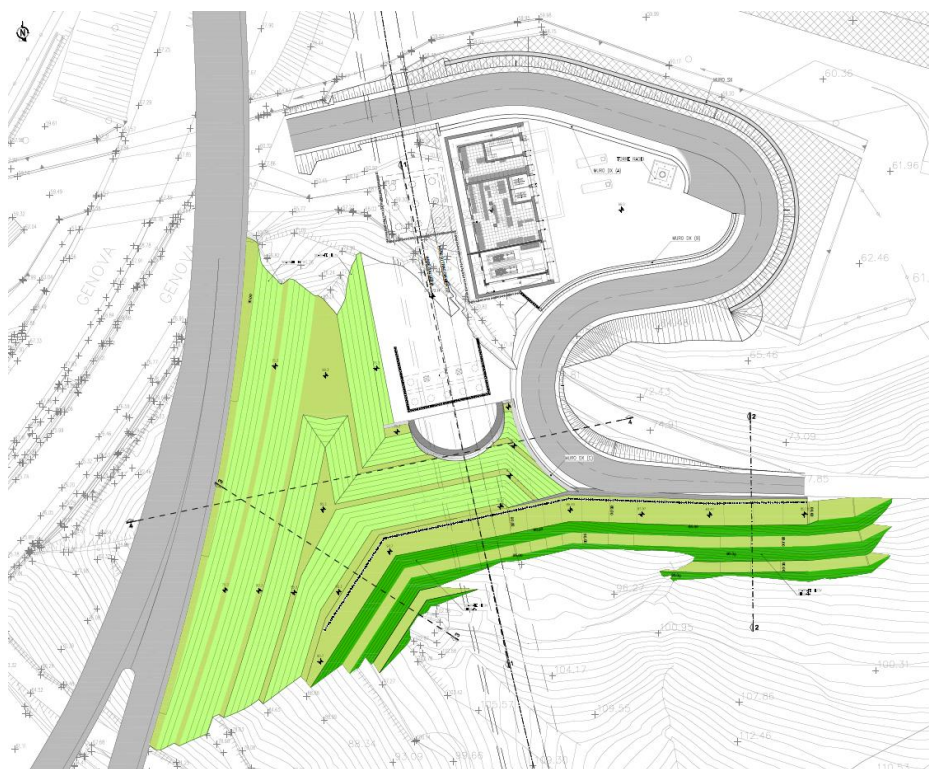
Planimetria delle sistemazioni finali dell'imbocco Forte Diamante
